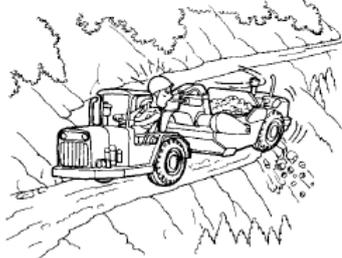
Precaución por descarrilamiento debido a la fuerza centrífuga
